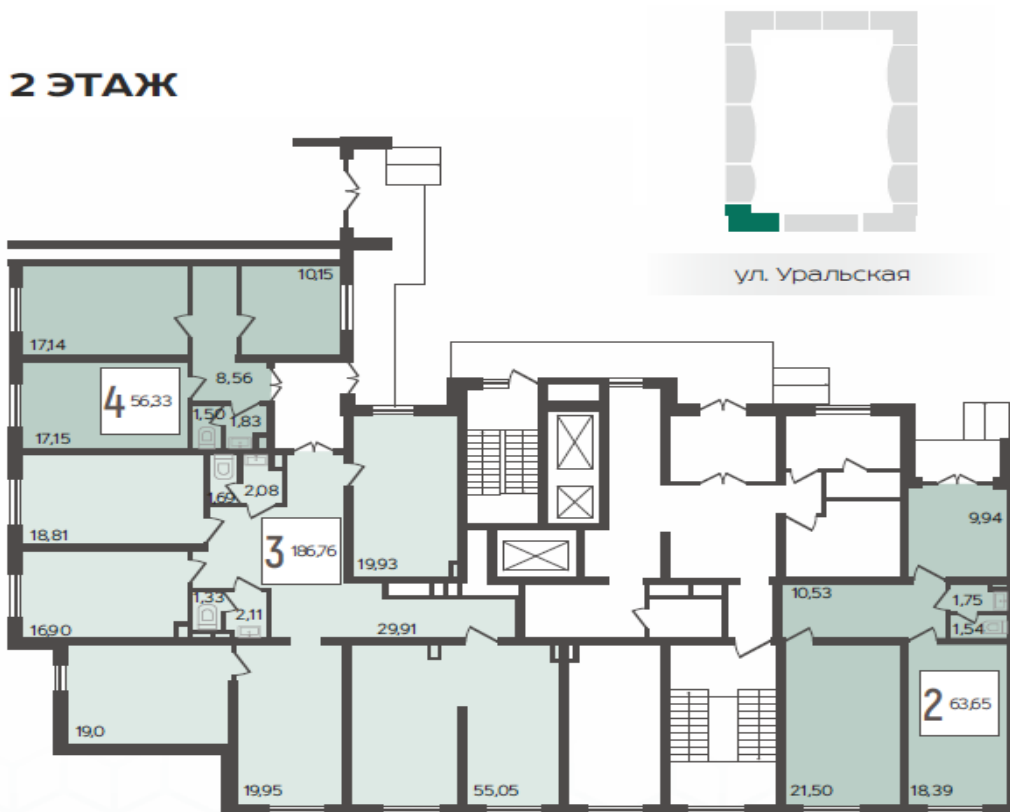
План коммерческих помещений 2 этажа БС-1 ЖК URAL
